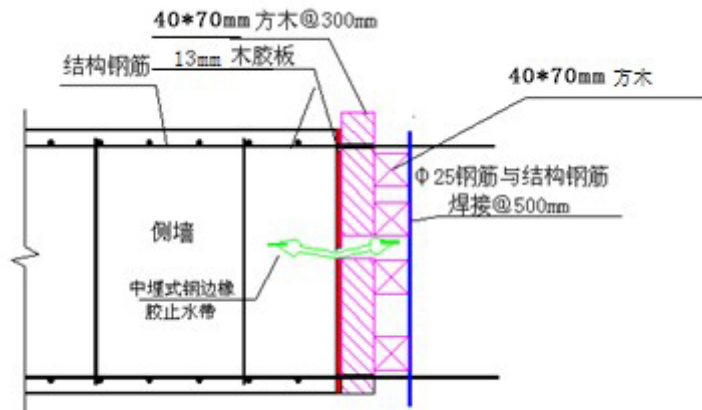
侧墙施工缝端头模板及支撑体系平面图
